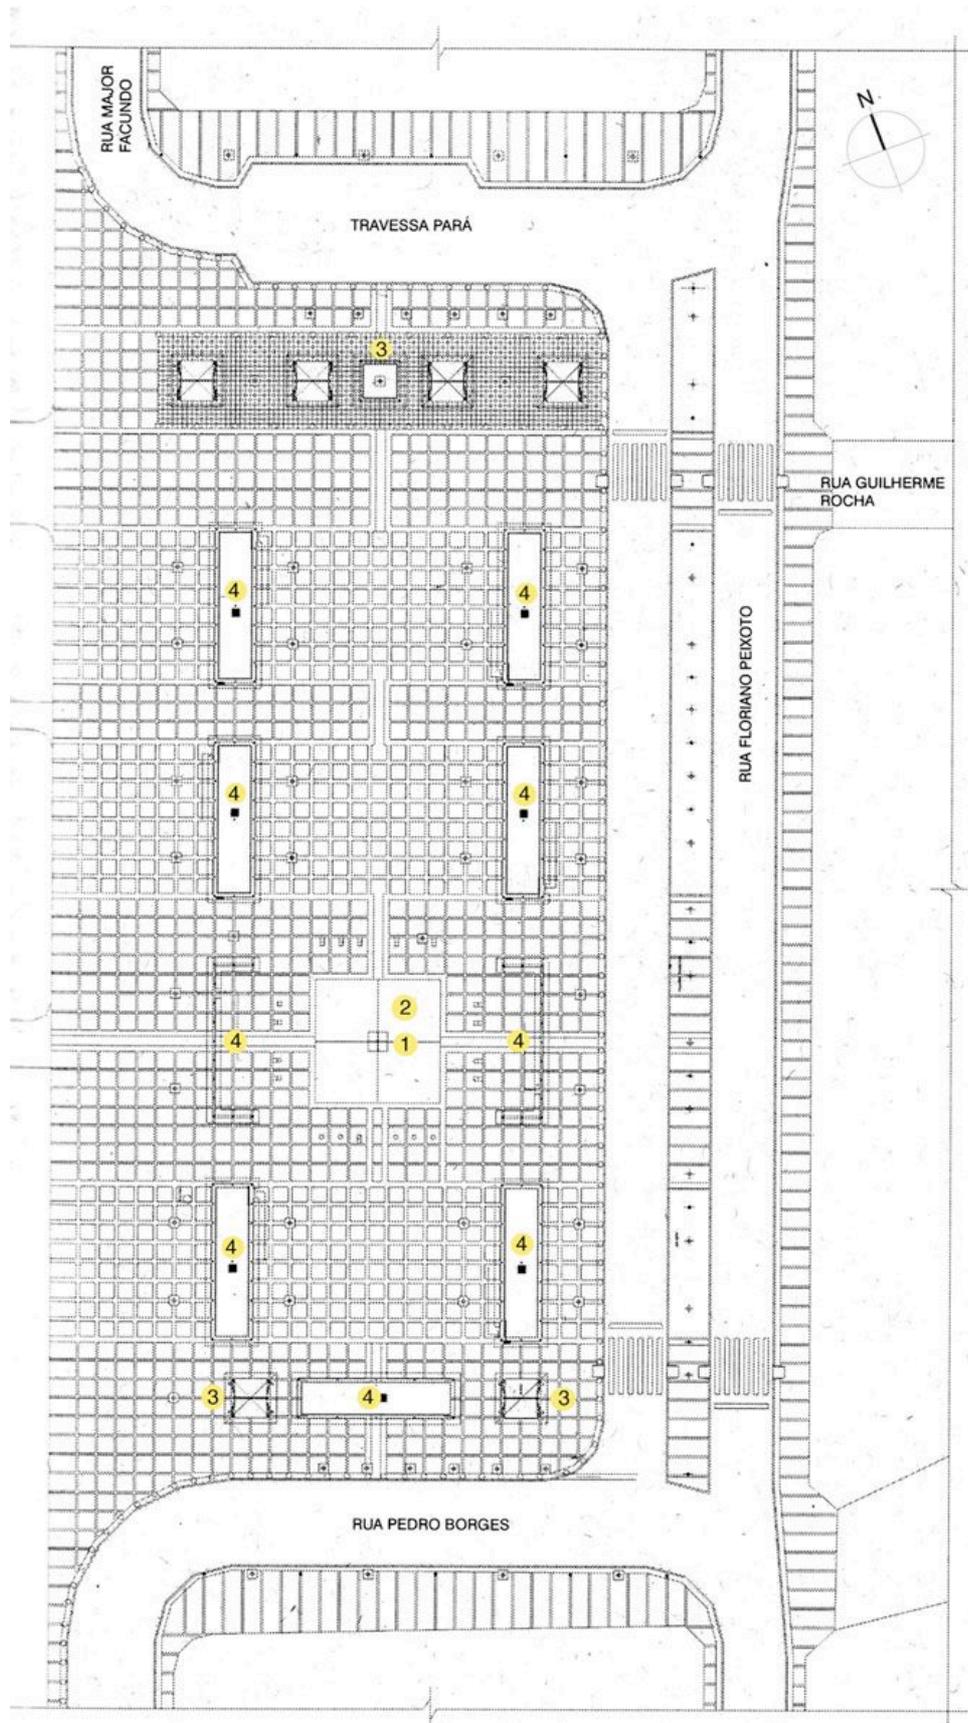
Planta da Praça do Ferreira: (1) Coluna da Hora; (2) Cacimba (poço); (3) Bancas; (4) Bancos;
